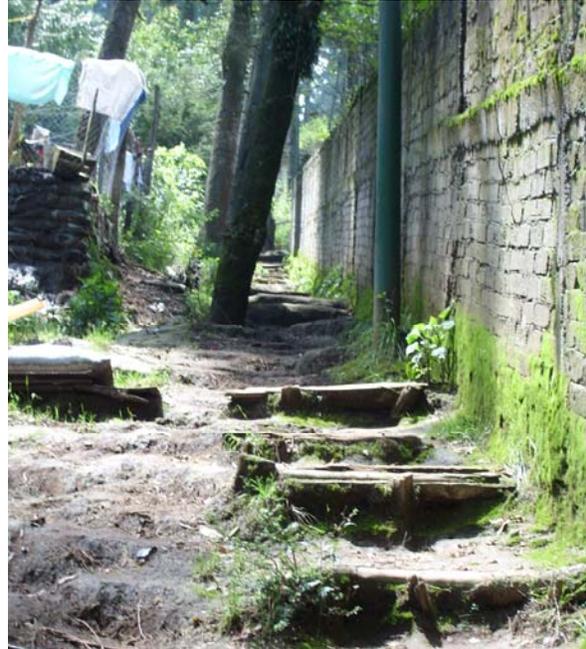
Muro y acceso a las viviendas ubicadas sobre la ladera
